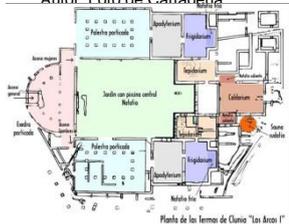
PLANTA DE TERMAS DE CLUNIA
